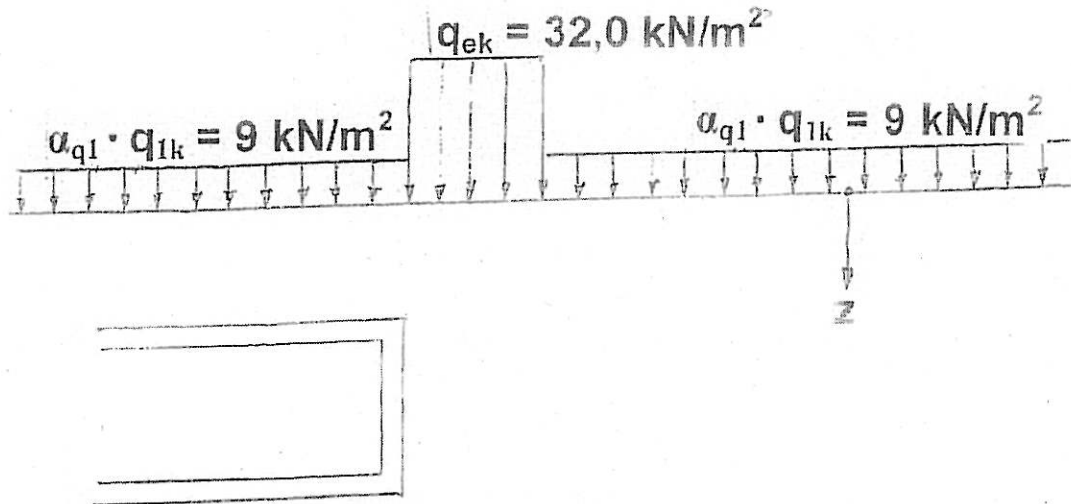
Belastung infolge Verkehr neben dem Tunnel
